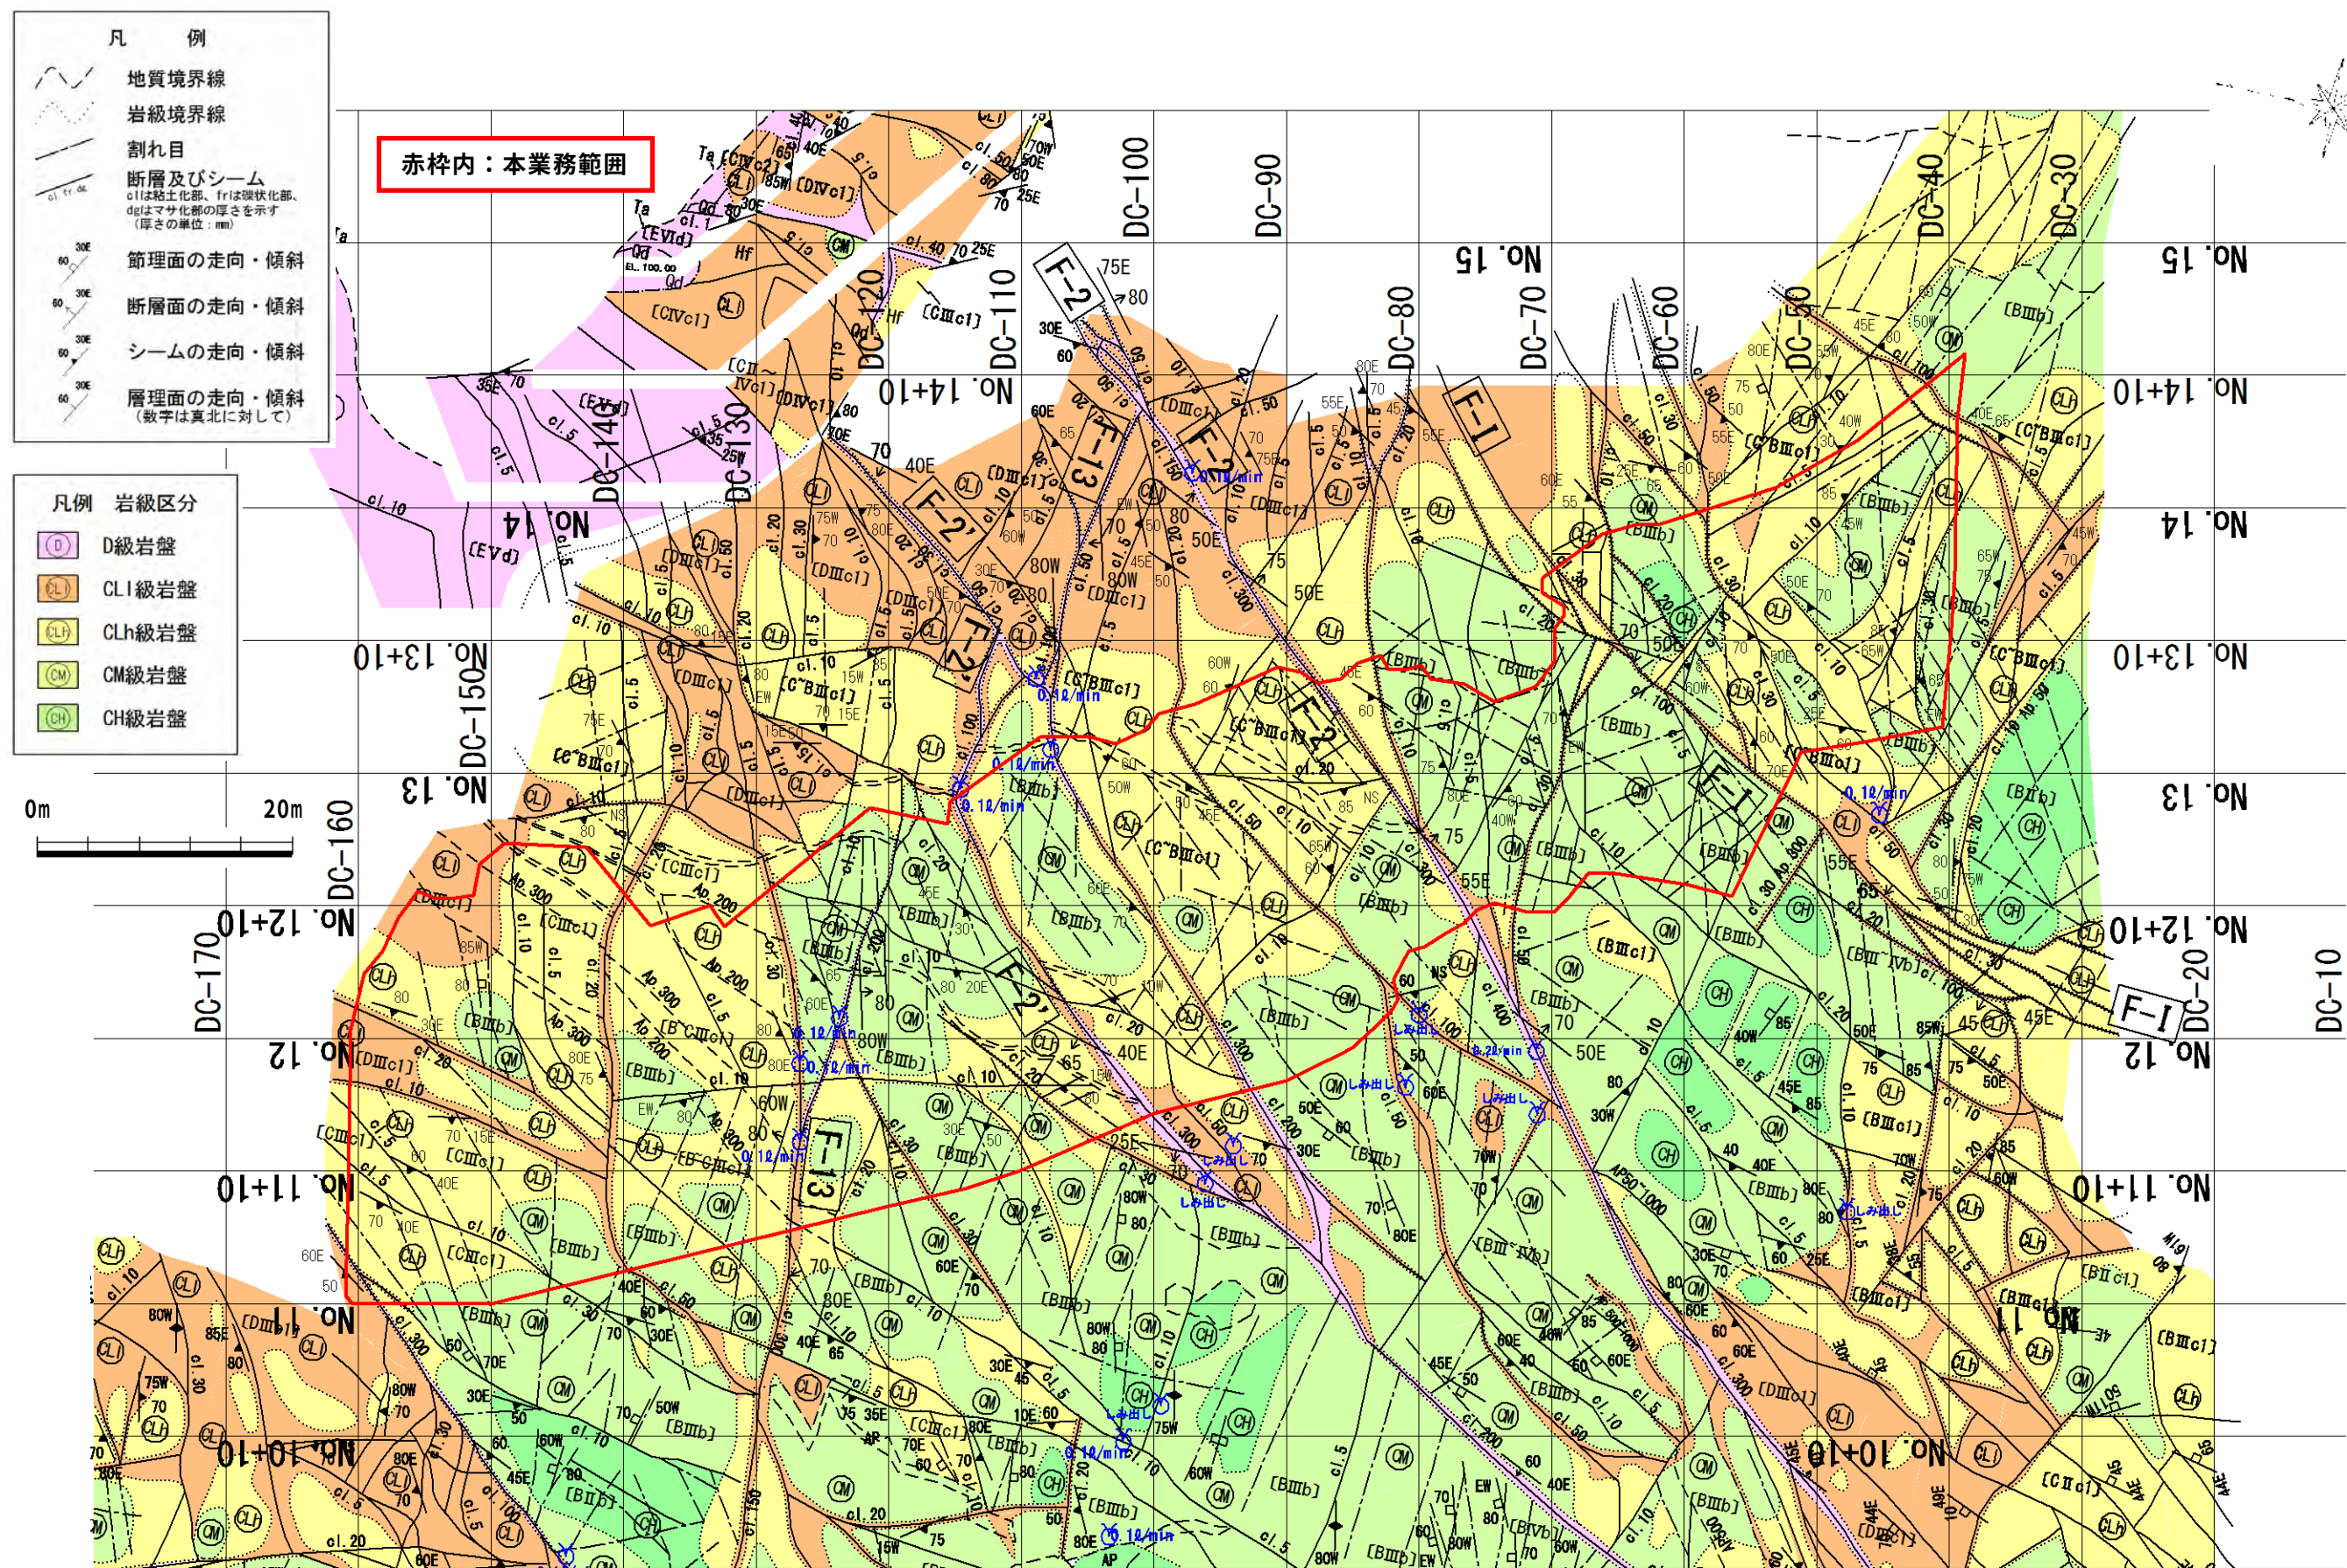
岩盤スケッチ平面図（岩級区分）（上流側）
